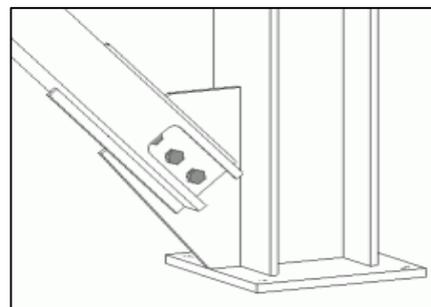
Gousset soudé sur l'aile du poteau
